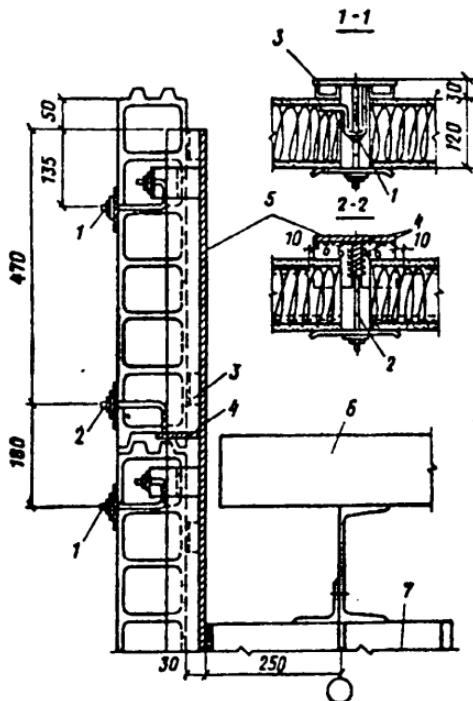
Крепление стеновых экструзионных панелей к насадке (выше уровня верха колонн):
